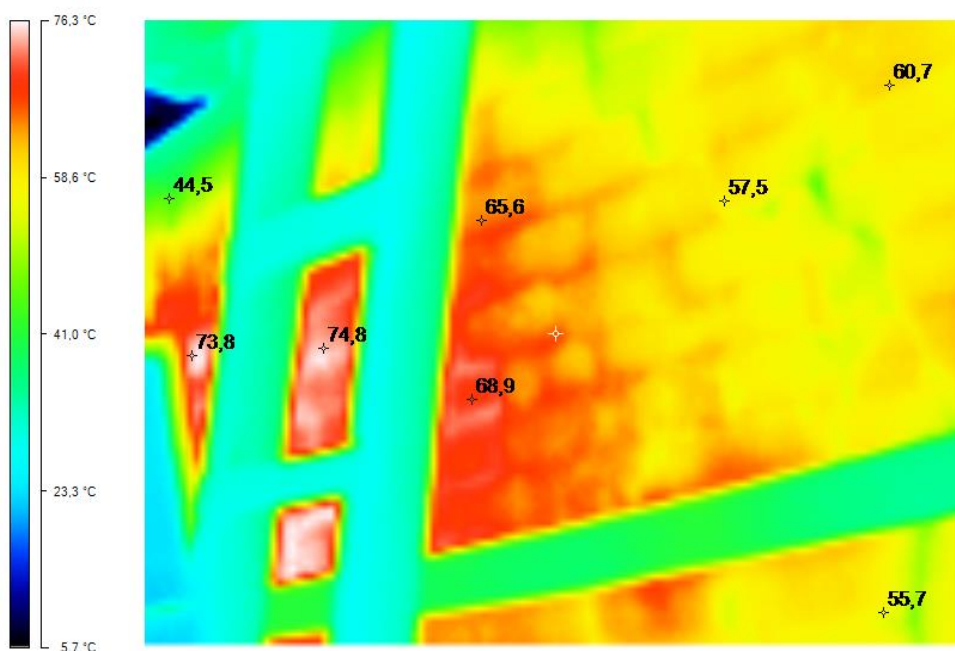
Стан мурування правої бічної поверхні робочого котла №1
